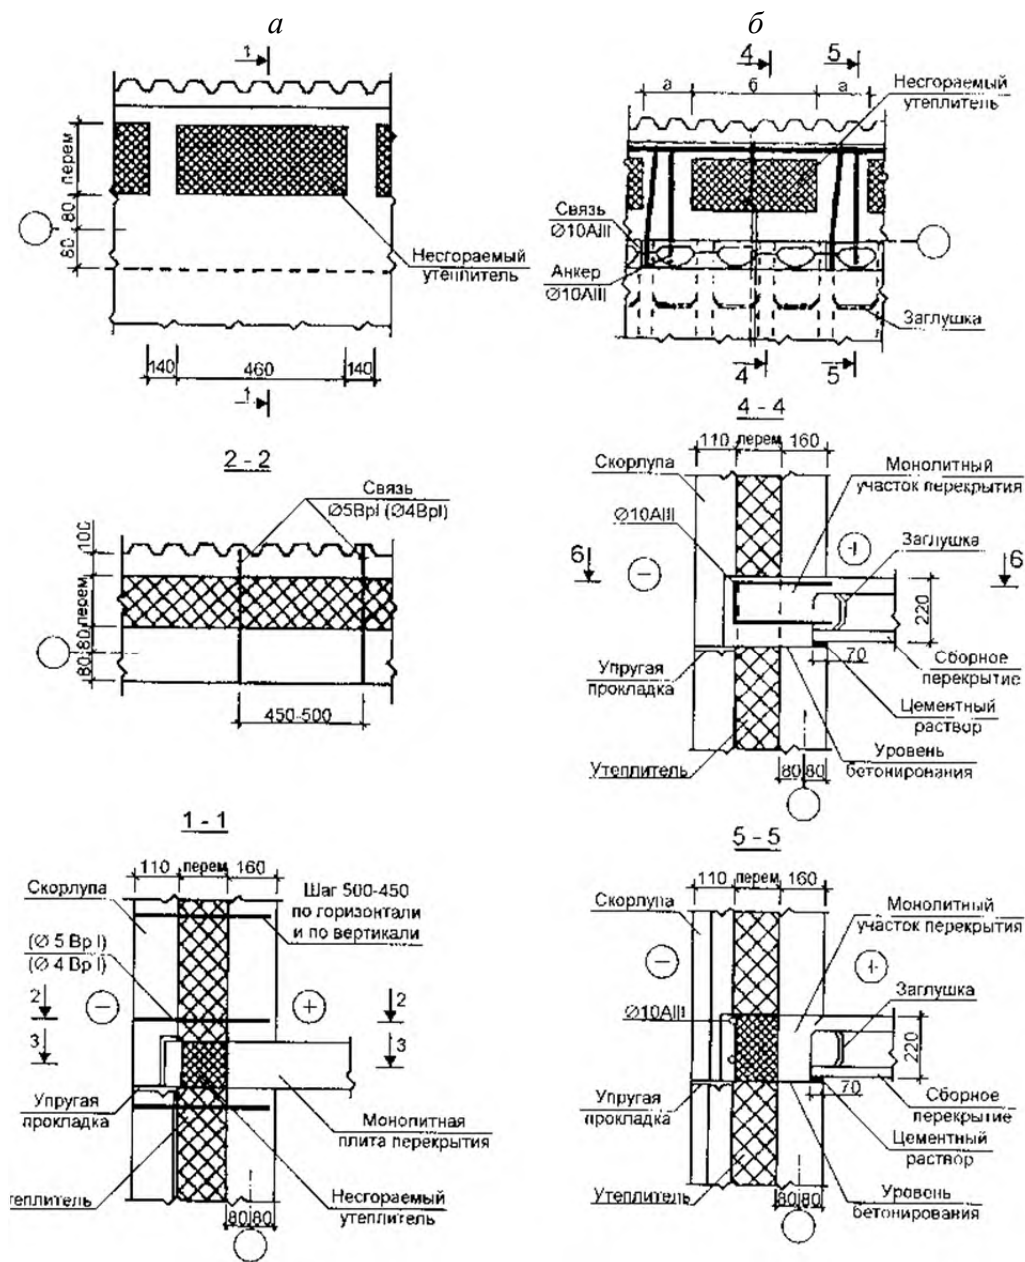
Монолитная слоистая наружная стена с железобетонными скорлупами:
